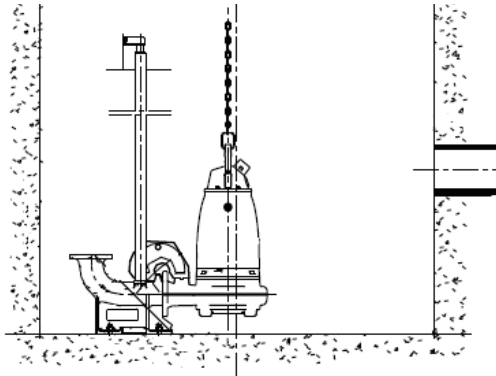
Sammelraum im Ortspumpwerk mit Tauchmotorpumpe
